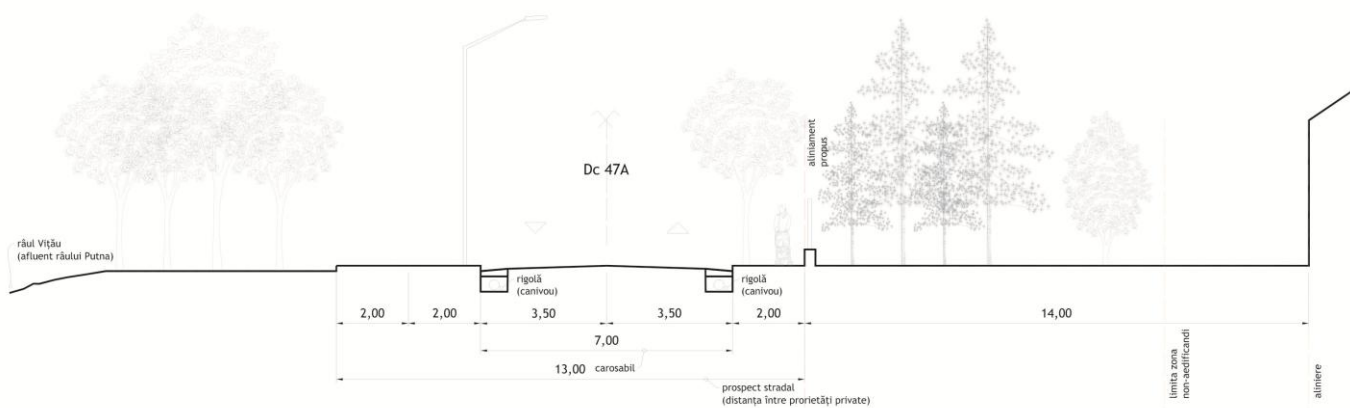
Secțiune caracteristică, Dc 47A, în intravilan
